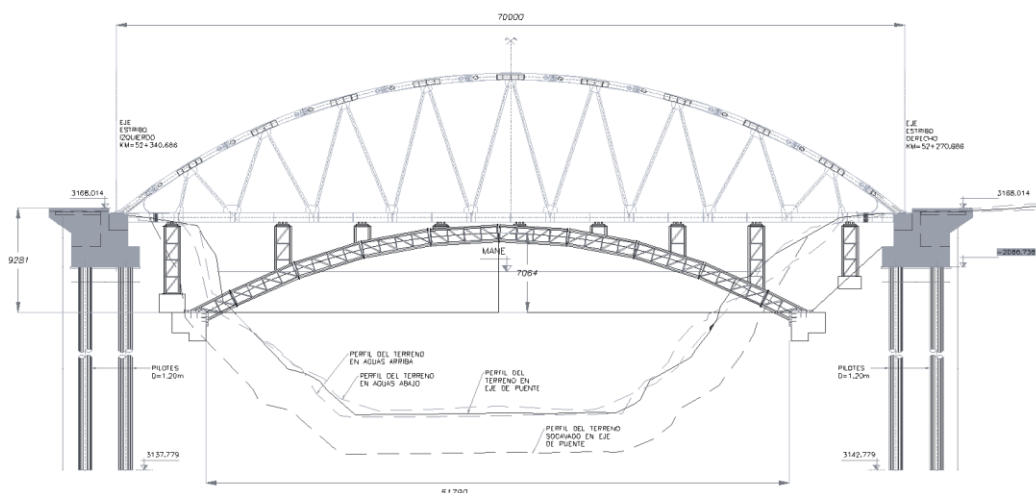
Propuesta para montaje del Puente Chupuro (Uso de falso puente en arco)
